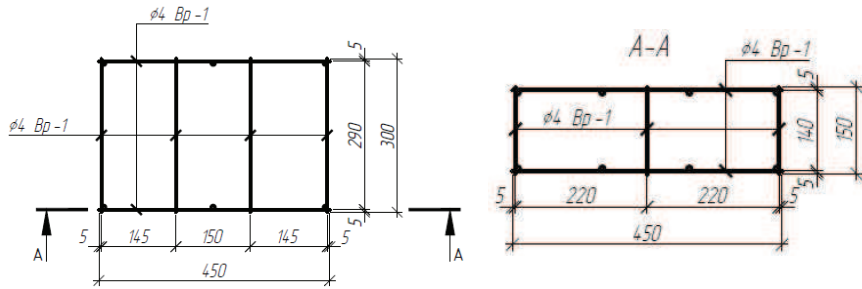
Схема армування залізобетонної плити 150×300×450 мм
